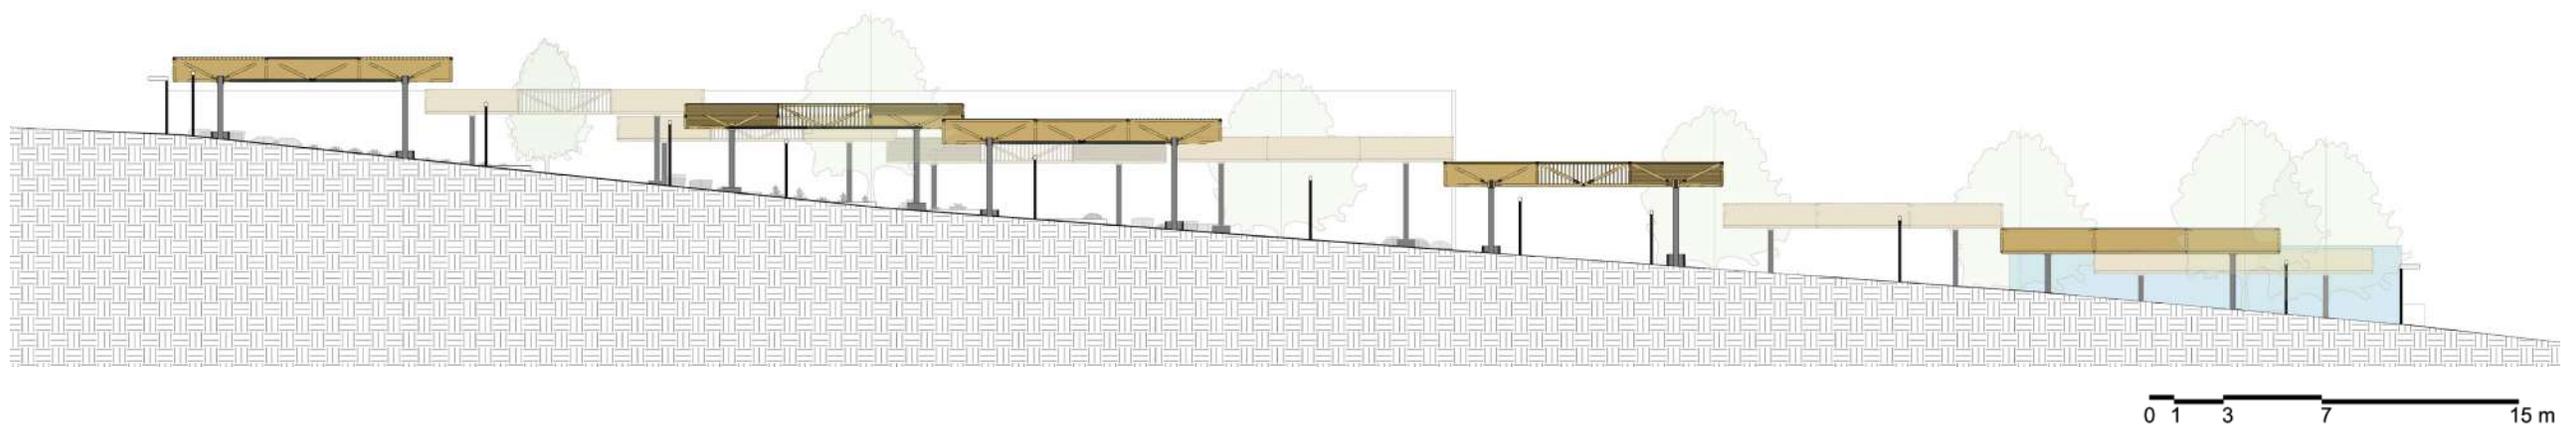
Corte Longitudinal 02 Sistema de Espaços Livres
